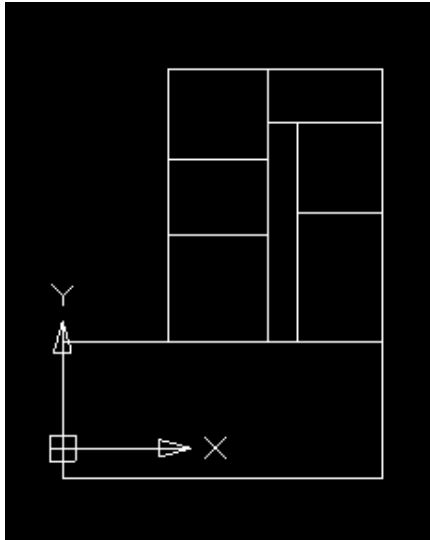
Planos en NanoCAD de la planta baja del edificio.
